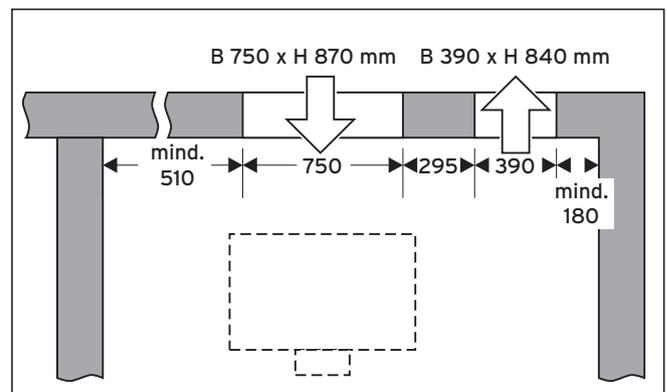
Wand-Installation, Luftaustritt rechts
